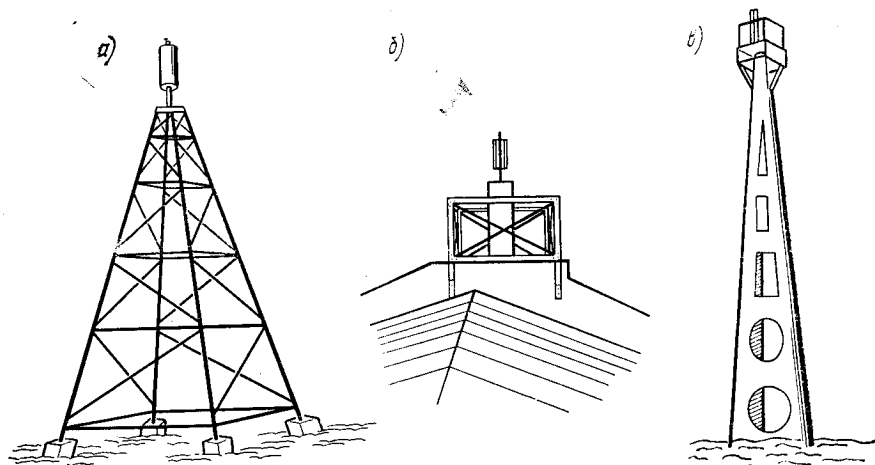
Металлическая пирамида (а), надстройка на здании (б) и бетонный сигнал (в)
